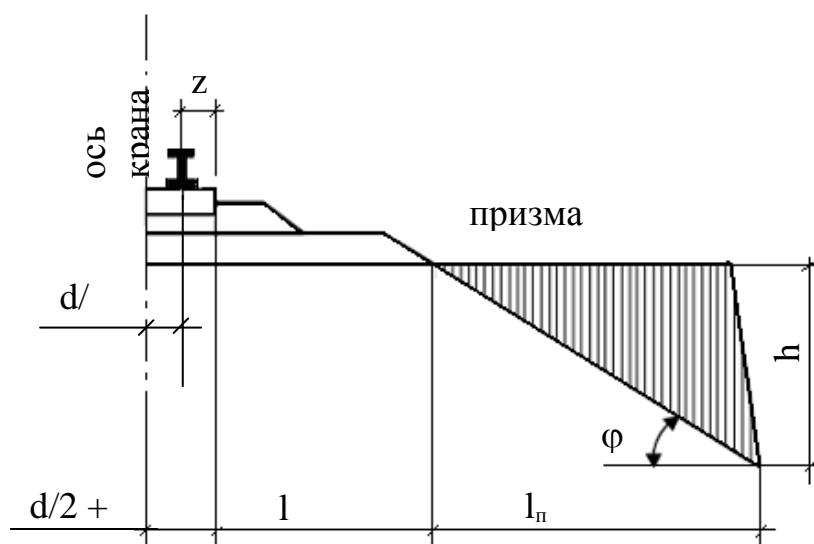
Расчетная схема расположения подкранового пути при открытом котловане
